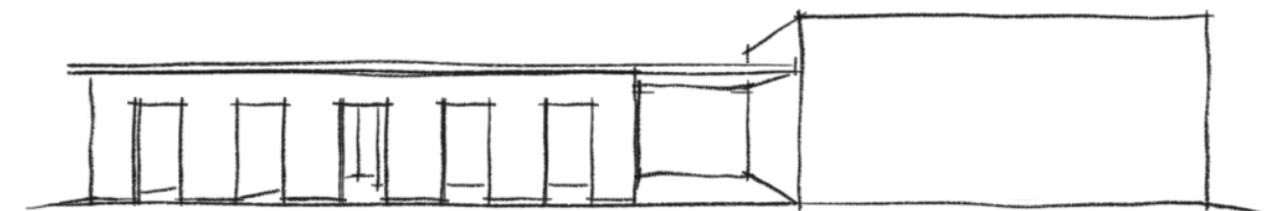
Propuesta de fachada del edificio sur del proyecto. (Hernández Reyes, 2021).
